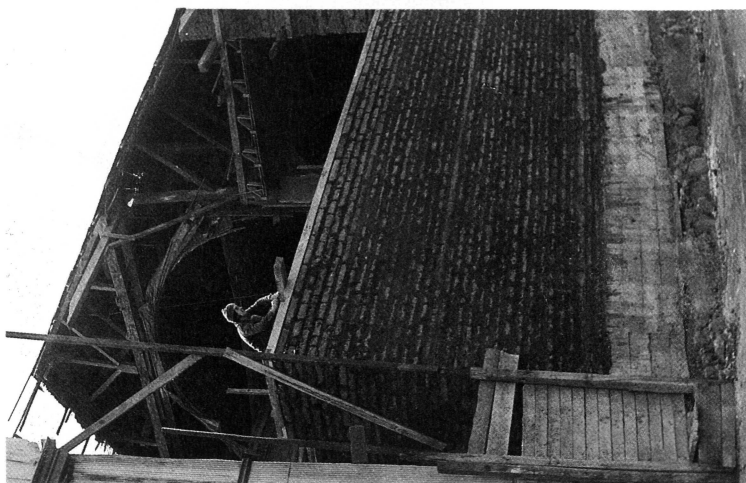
Vista del ábside reconstruido en adobe y del sistema estructural de la techumbre.
